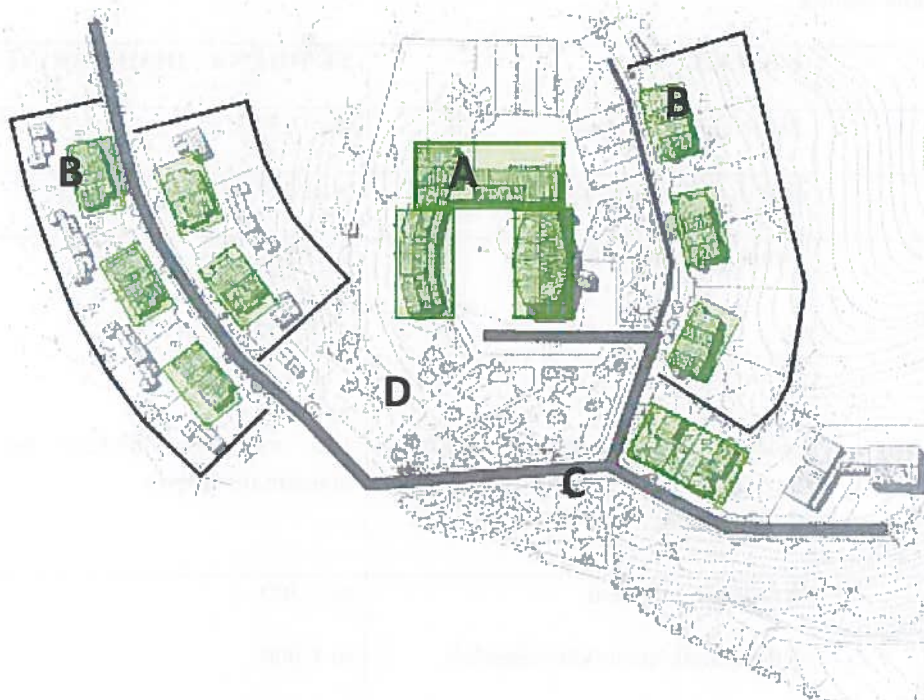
Skema e ndërhyrjes : plan , Stebleve shembull 2
